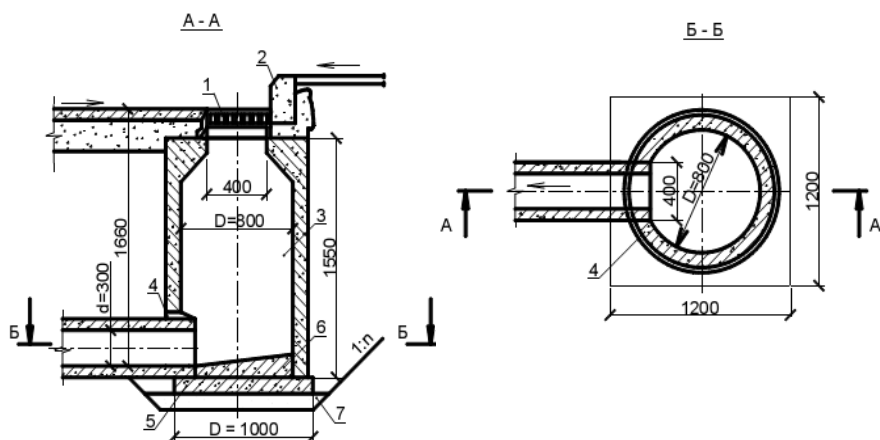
Дождеприемник из сборных железобетонных элементов:
